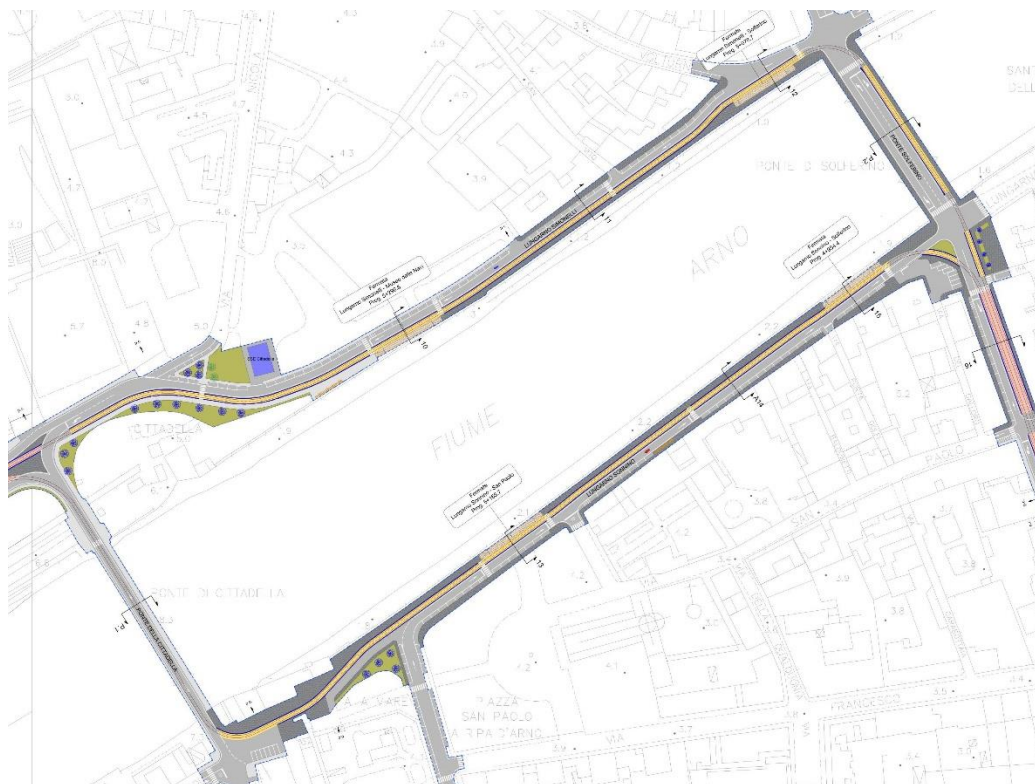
Planimetria di progetto Lungarno Simonelli e Sonnino
